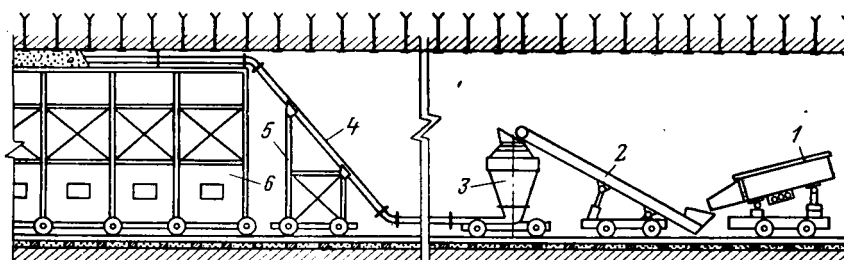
Схема механизированной укладки бетонной смеси за опалубку
